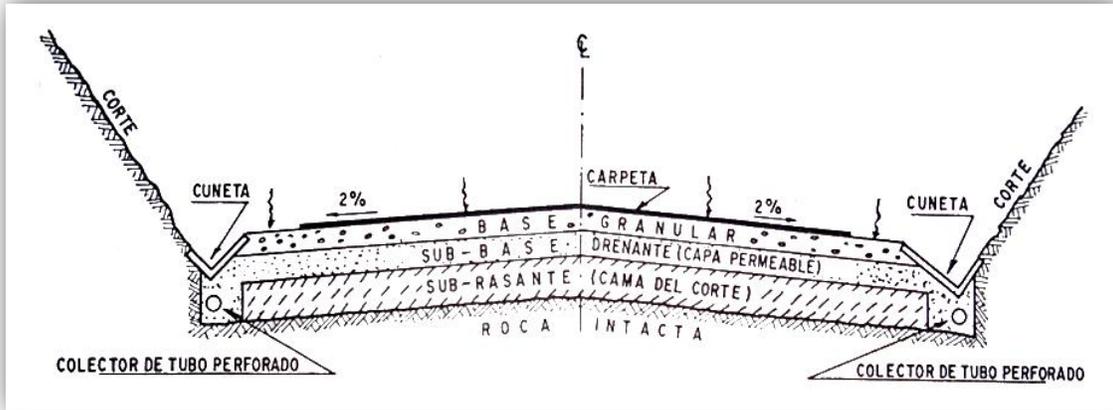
Sub-base utilizada como capa permeable, para interceptar agua proveniente del pavimento.
